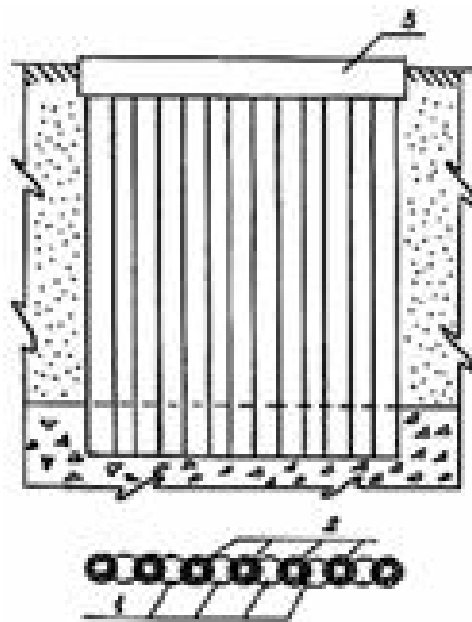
Схема фундамента из буресекущихся свай: 1 – первоочередные бетонные сваи, 2 – железобетонные сваи, выполняемые между бетонных свай, 3. – объединяющий ростверк
